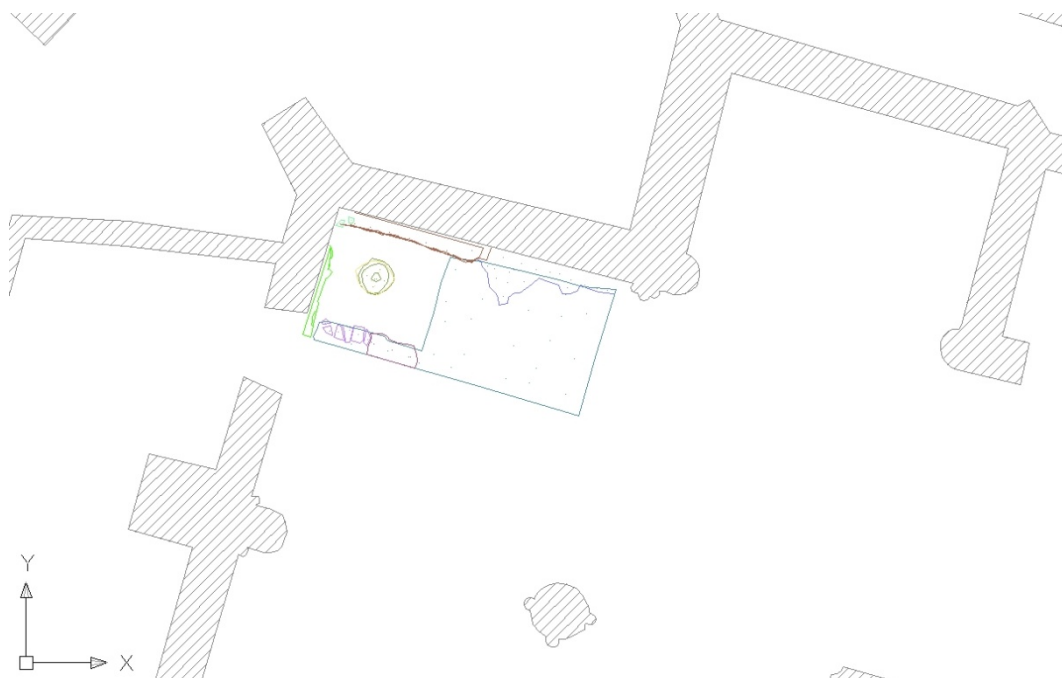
Vista en planta de algunos de los elementos documentados de la excavación con la planta redibujada.
